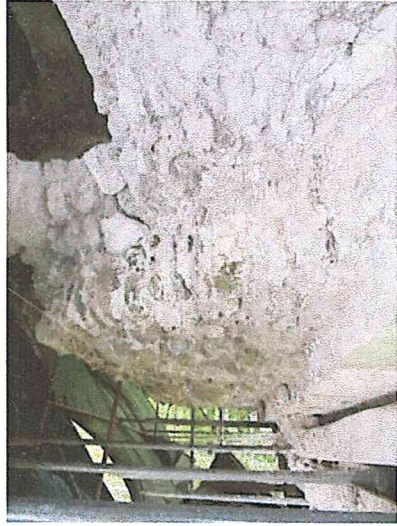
54, Vista del proceso y terminado de restitución de volumen en muro Este exterior entre cámara Sur y cámara Norte.
